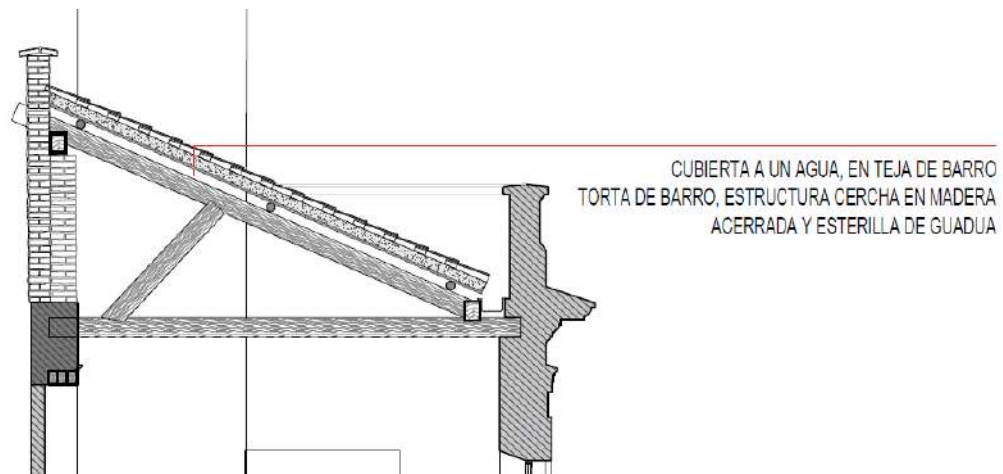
Corte estructura de cubierta edificio "La Flauta"
